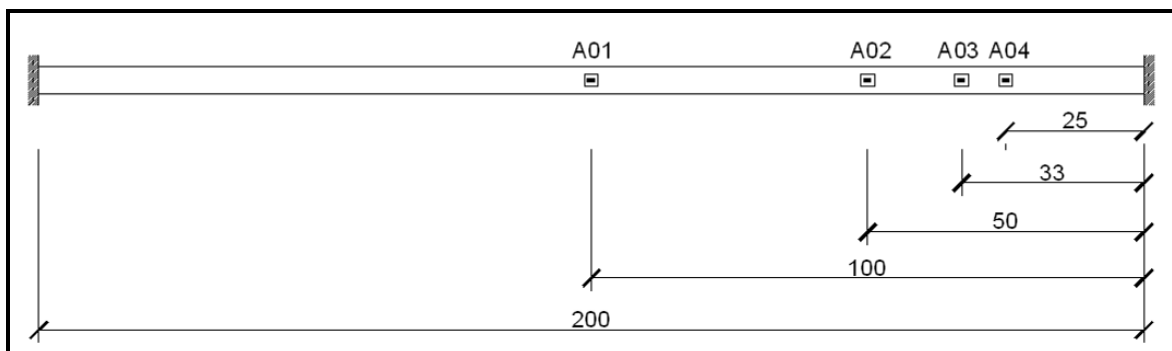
Esquema de instrumentação da viga bi-engastada em planta (medidas em centímetros)
